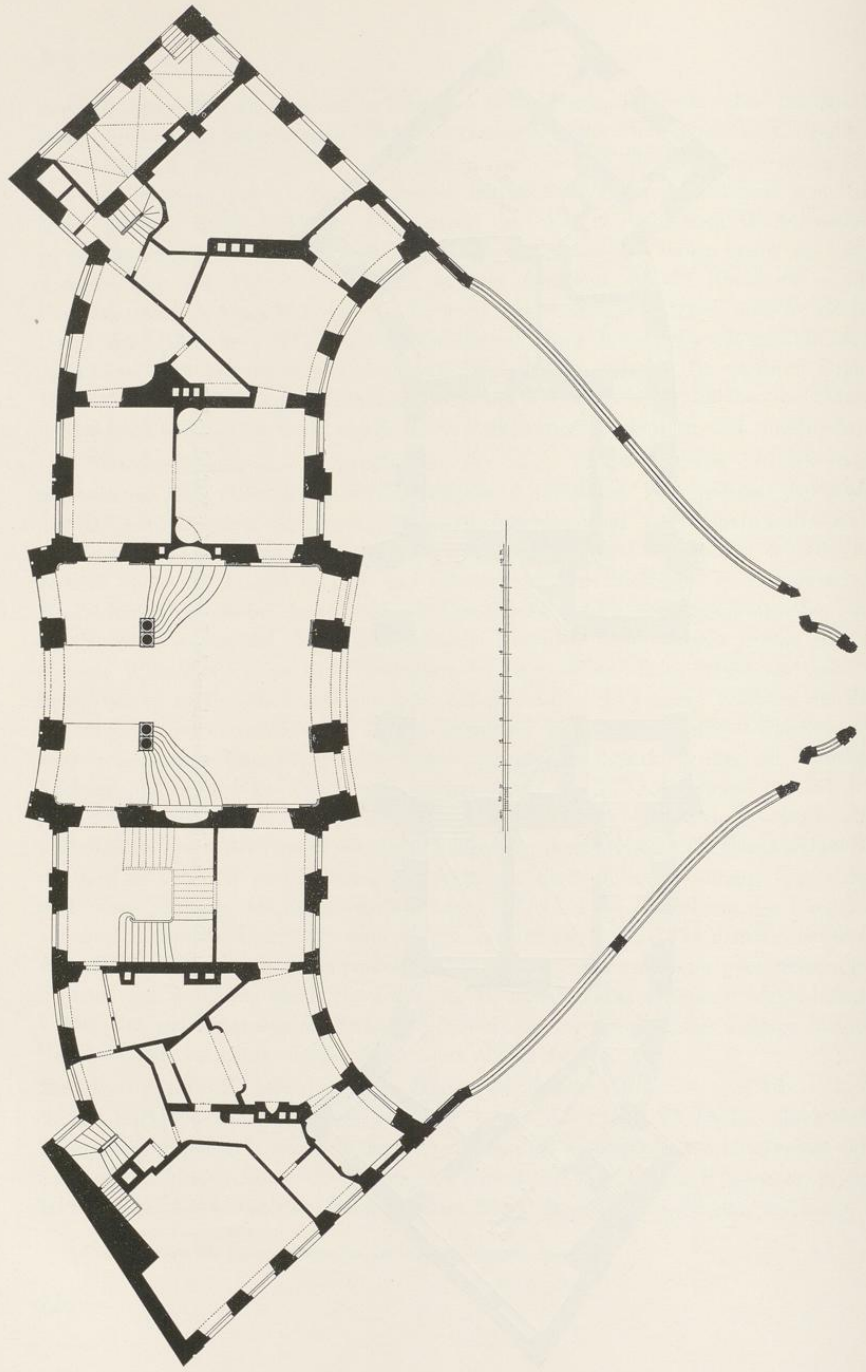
Grundriß des Erdgeschosses des Erdrostenhofes
